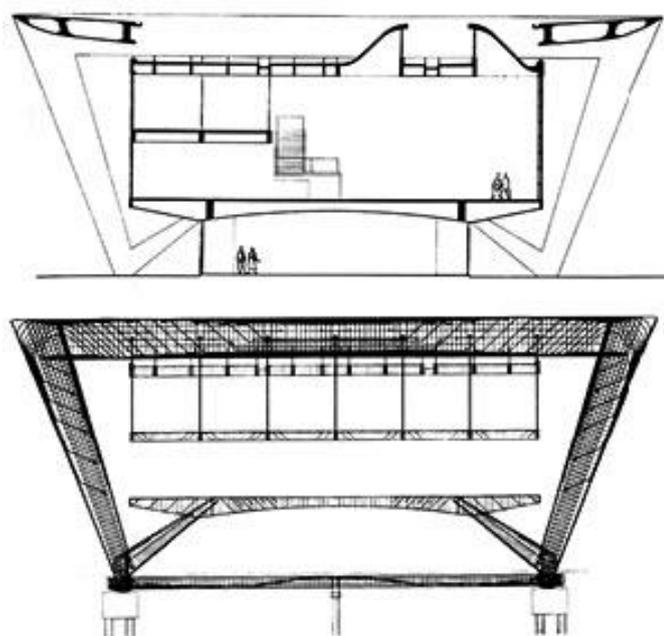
Vista transversal do modelo do pórtico do MAM – RJ. Centro de Documentação de Pesquisa do MAM, André Turazzi (CC BY-NC-AS) 1952, apud ARCHDAILY, 2014.
